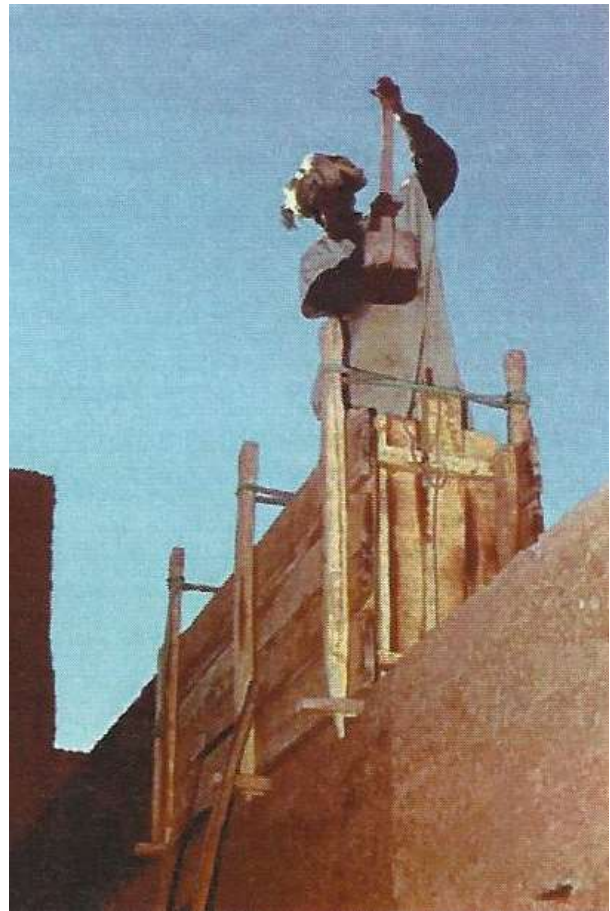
Detalle de construcción de tapial. (Imagen de Michel Lebrun: L'architecture de terrea u Maroc)²³
